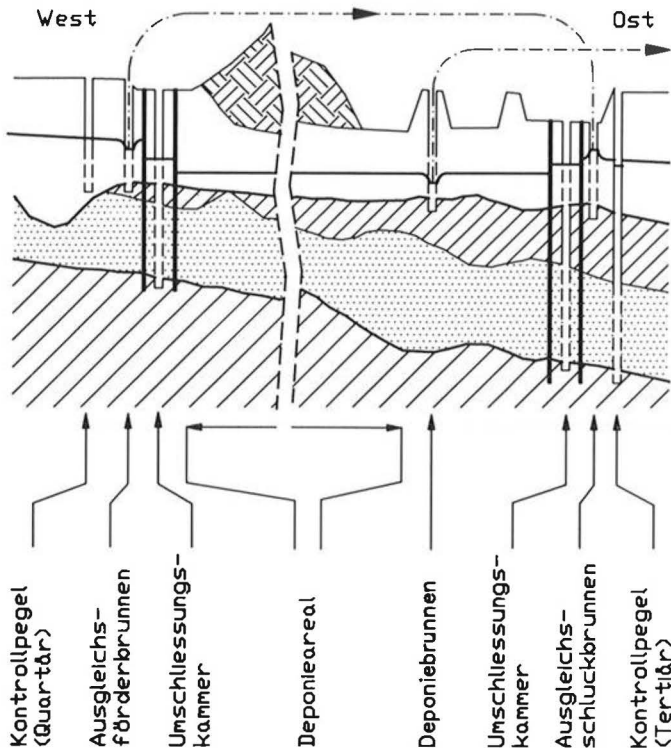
Querschnitt des umschlossenen Areals mit Dichtwänden (schematisch); Betriebsschema der Wasserhaltungen.
